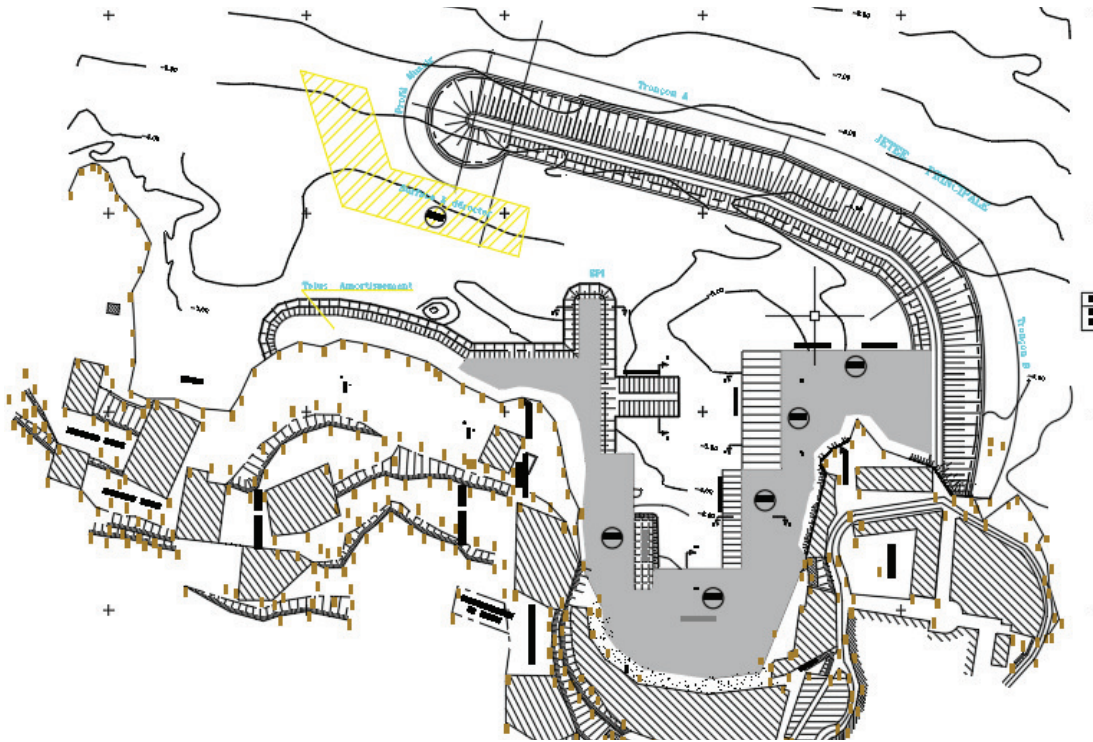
Plan de masse de la variante 1 d'aménagement
